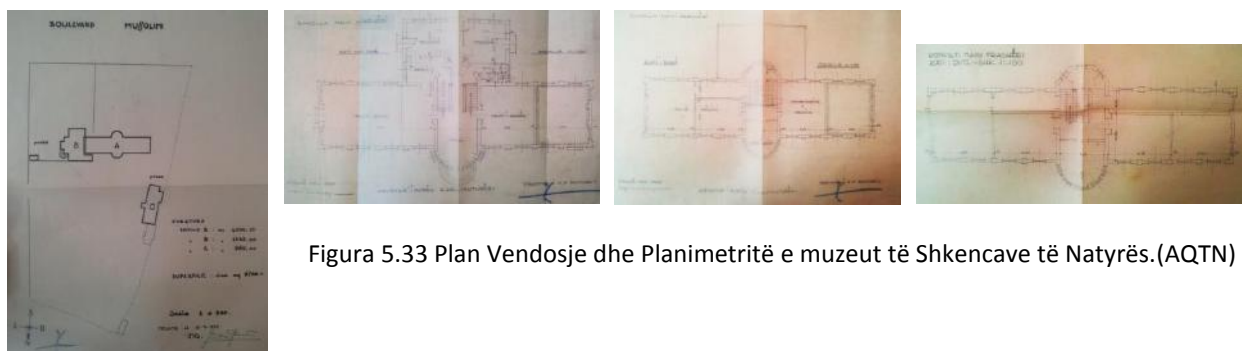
Plan Vendosje dhe Planimetritë e muzeut të Shkencave të Natyrës.(AQTN)
